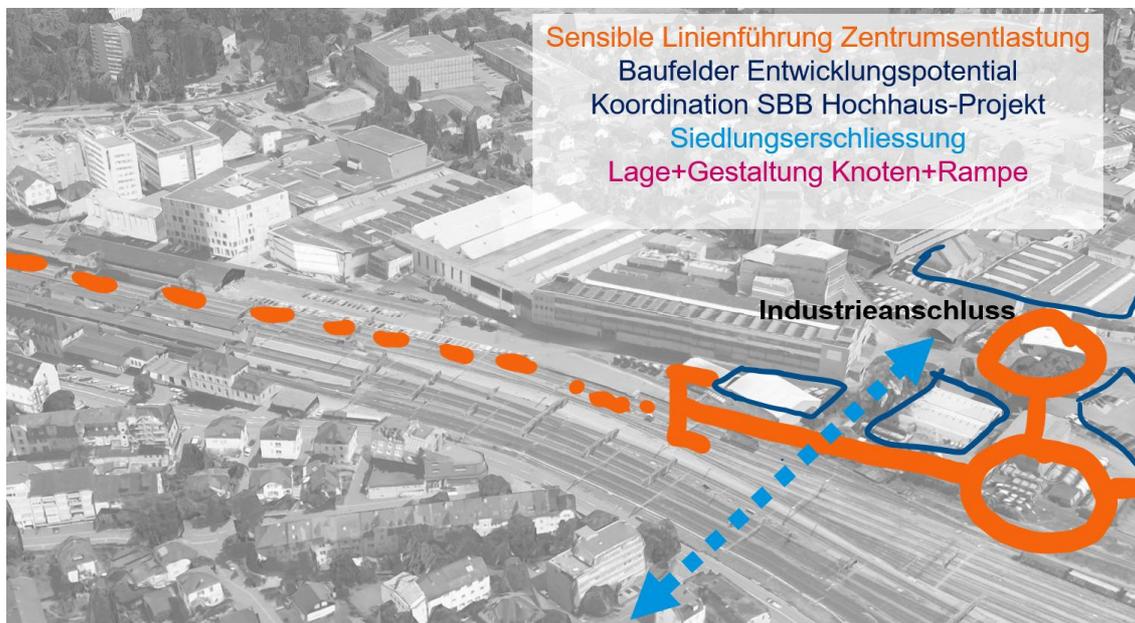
Tunnelportal Süd mit Betriebsanschluss Industrie und neuer Velounterführung (Quelle: Planteam)
